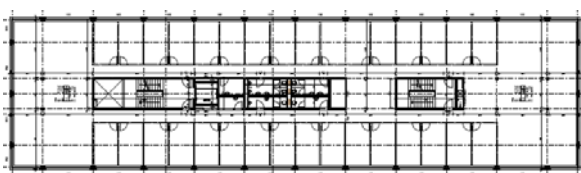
Grundriss eines Normalgeschosses. Das Dienstleistungsgebäude verfügt über insgesamt vier Geschosse.
